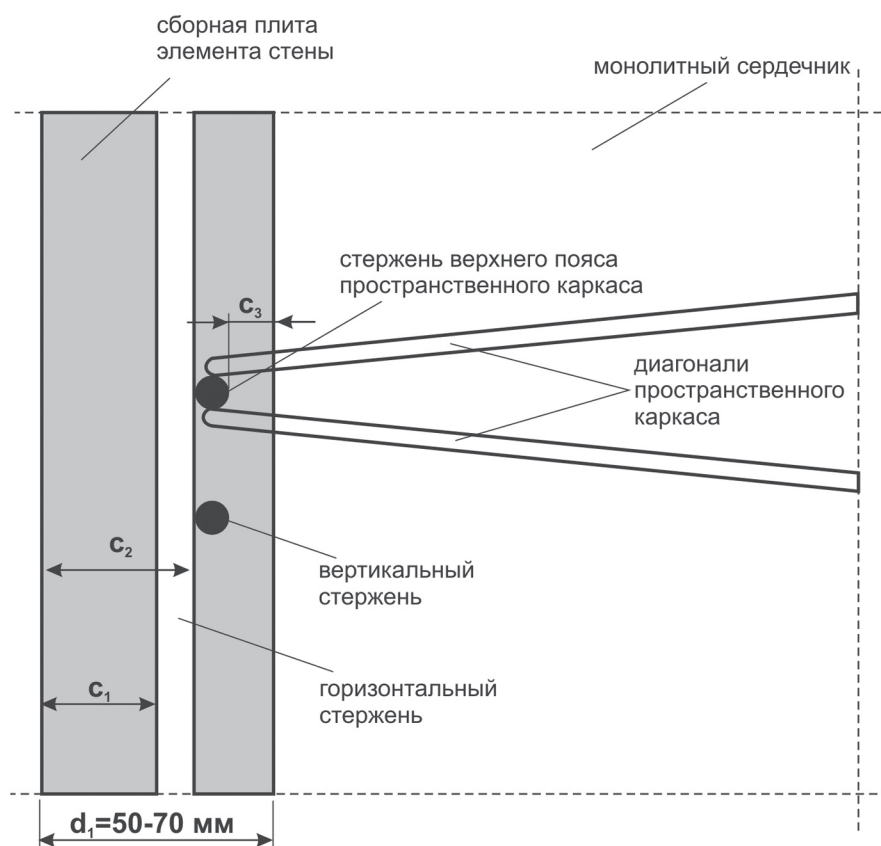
Фрагмент элемента несъемной опалубки стены
